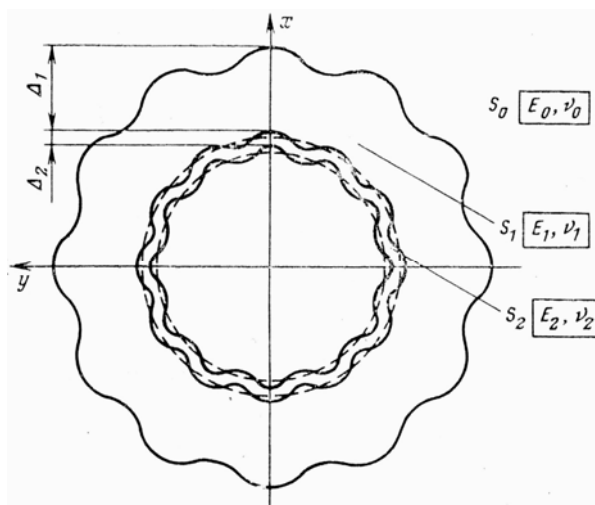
Расчетная схема к решению задачи по определению параметров набрызгбетонной крепи [126]
